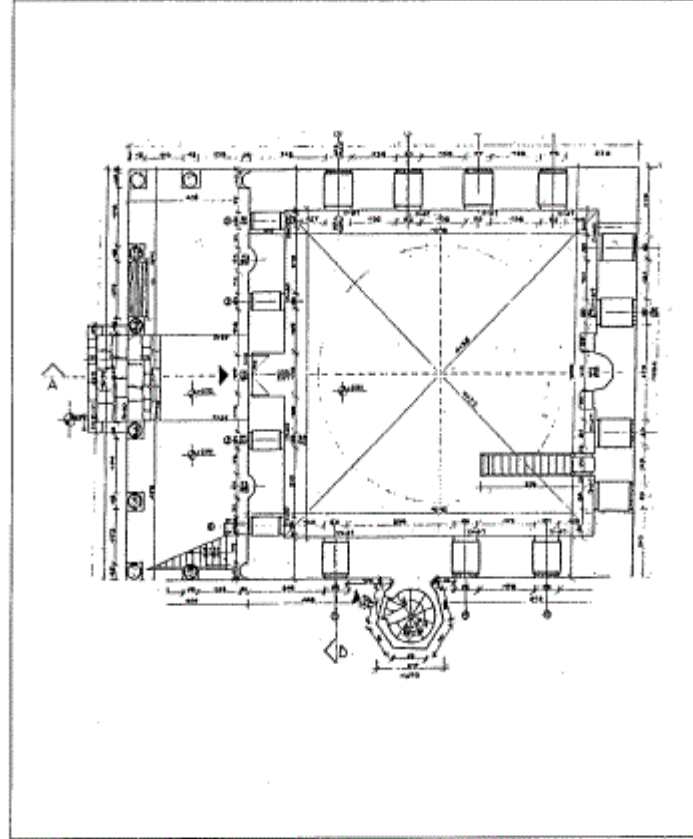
مسقط أفقي للمسجد الجديد (بنى جامع) في كوموتينى (عن : كيل).
